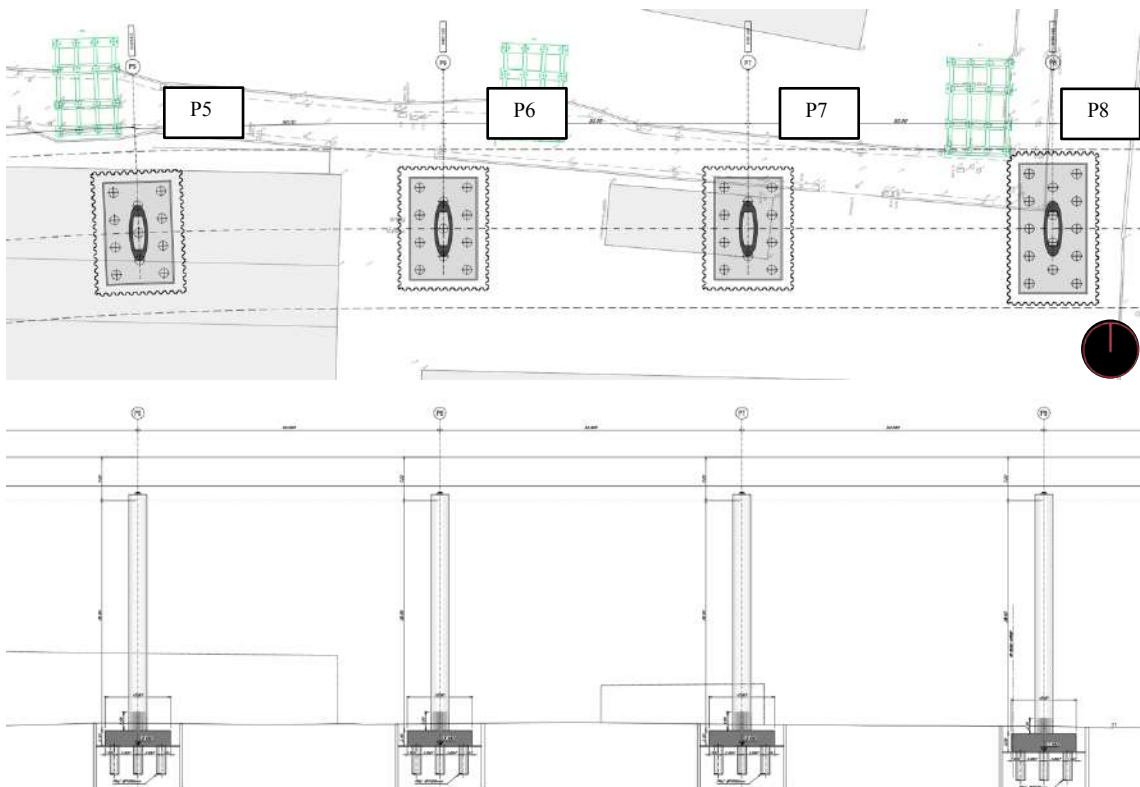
Planta e elevação lateral dos pilares elípticos P5, P6, P7, P8 e respectivas fundações. Fonte: Adaptada de ITALFERR
